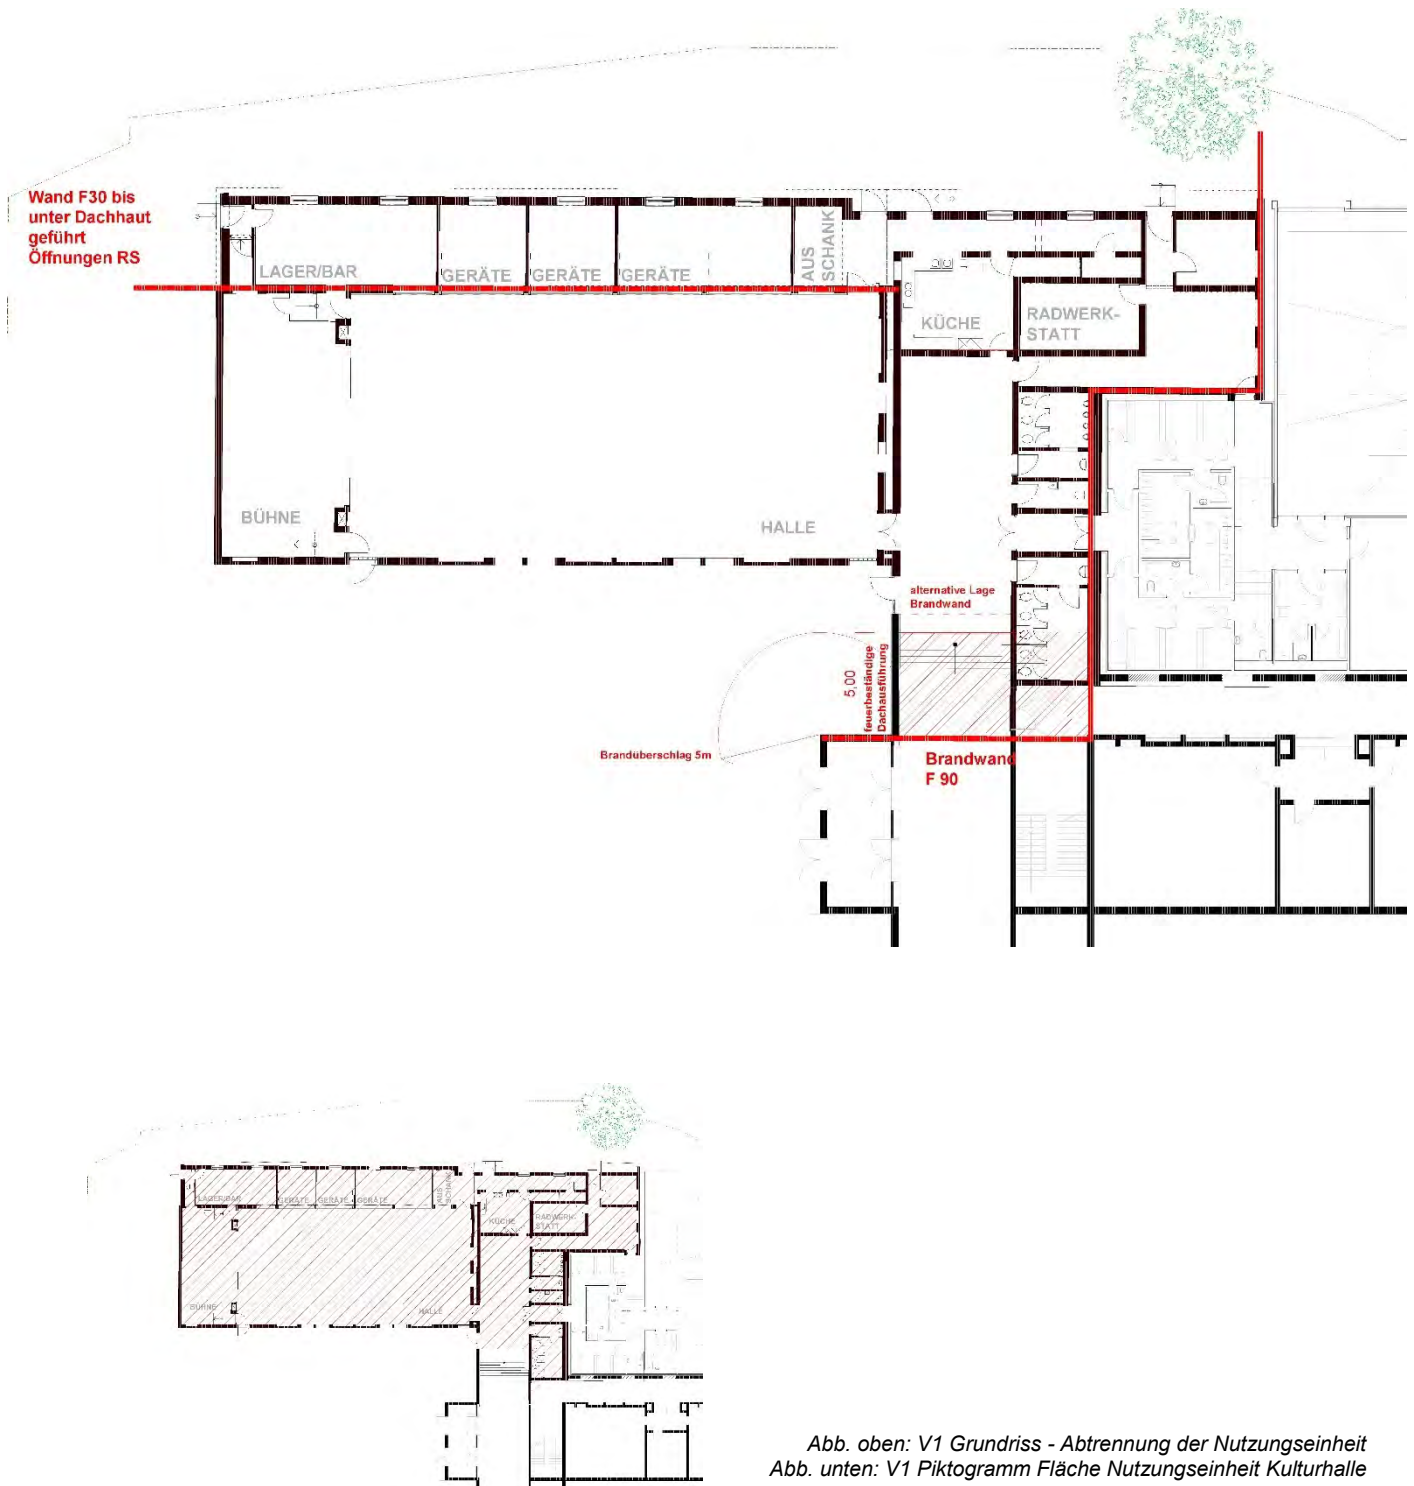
Grundriss - Abtrennung der Nutzungseinheit
